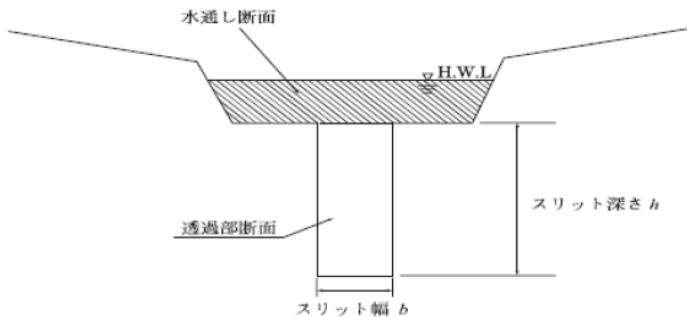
コンクリートスリット砂防堰堤の水通り断面と透過部断面
